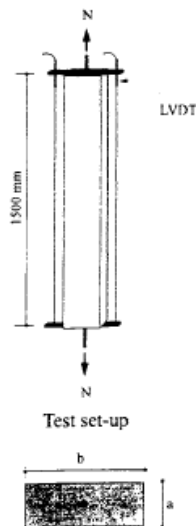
Espécimen del tirante que se realizara el ensayo a tracción. (Influence of Splitting Crack on Tesion Stiffening, Abrisham, Mitchell, 1996)
